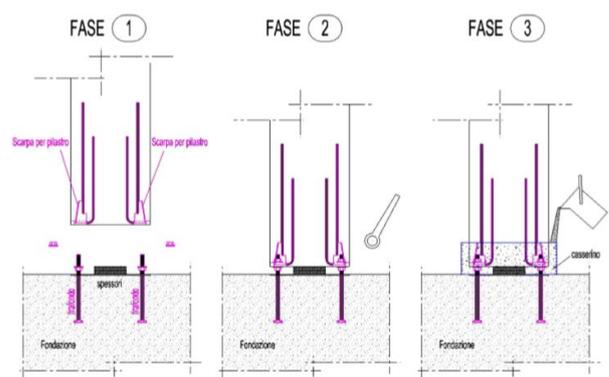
Fasi di sigillatura del collegamento pilastro-pilastro
